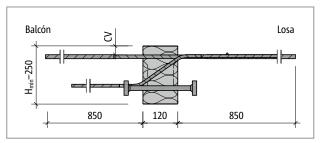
Schöck Isokorb® XT tipo K-M7 hasta M10 en R0: Sección del producto
